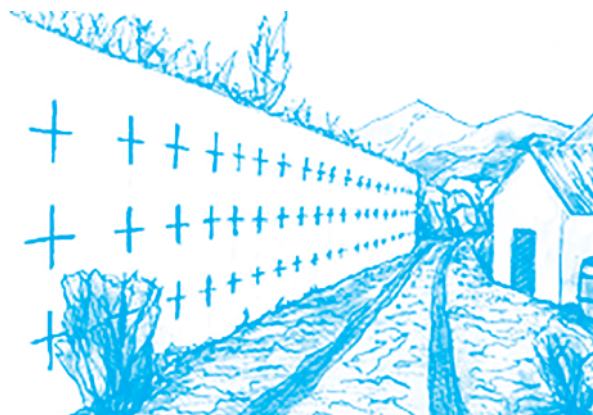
Подпорная армогрунтовая стена с облицовкой из железобетонных блоков (рис. Павла Мачерета)
